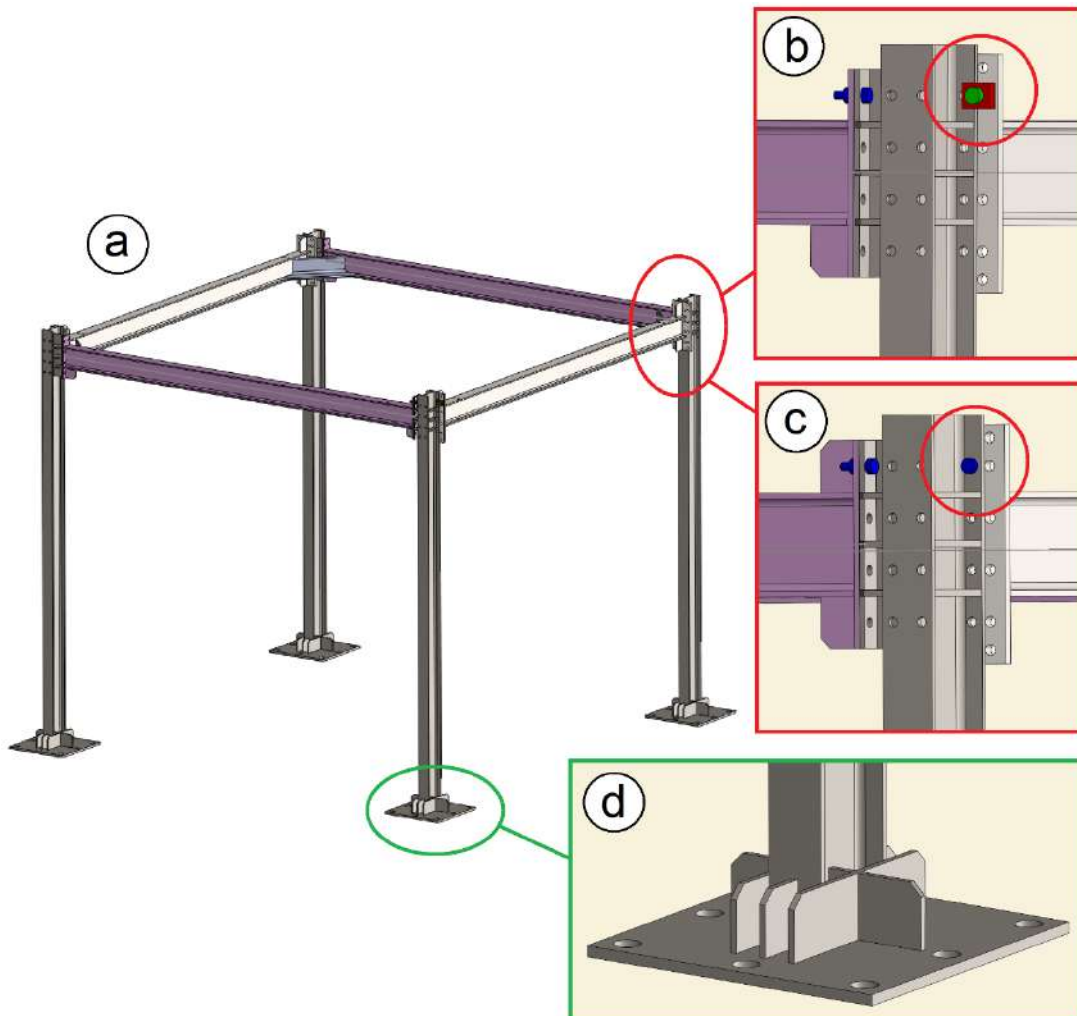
Modelo del pórtico ensayado en laboratorio. a) Detalle unión grapada. b) Detalle unión atornillada. c) Detalle de base de los pilares del pórtico ensayado en laboratorio.
